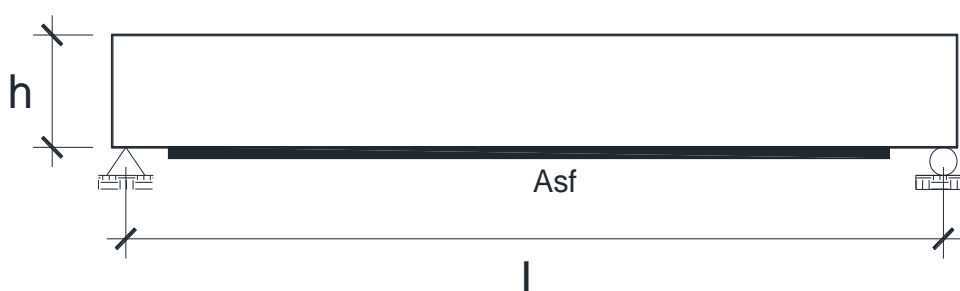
Esquema de colocado de Refuerzo CFRP en las vigas a ensayar.
